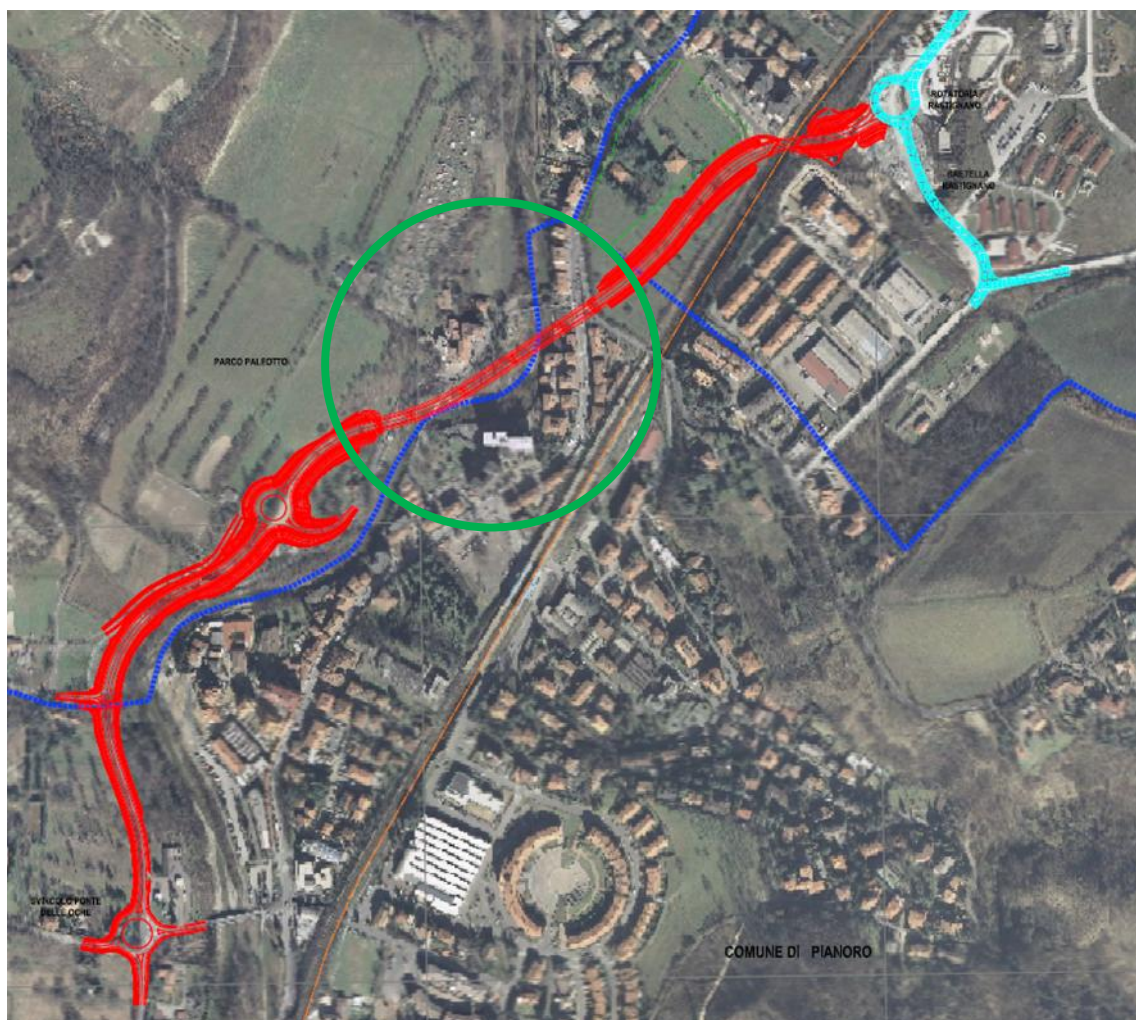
Progetto su ortofoto con individuazione dell'opera.
